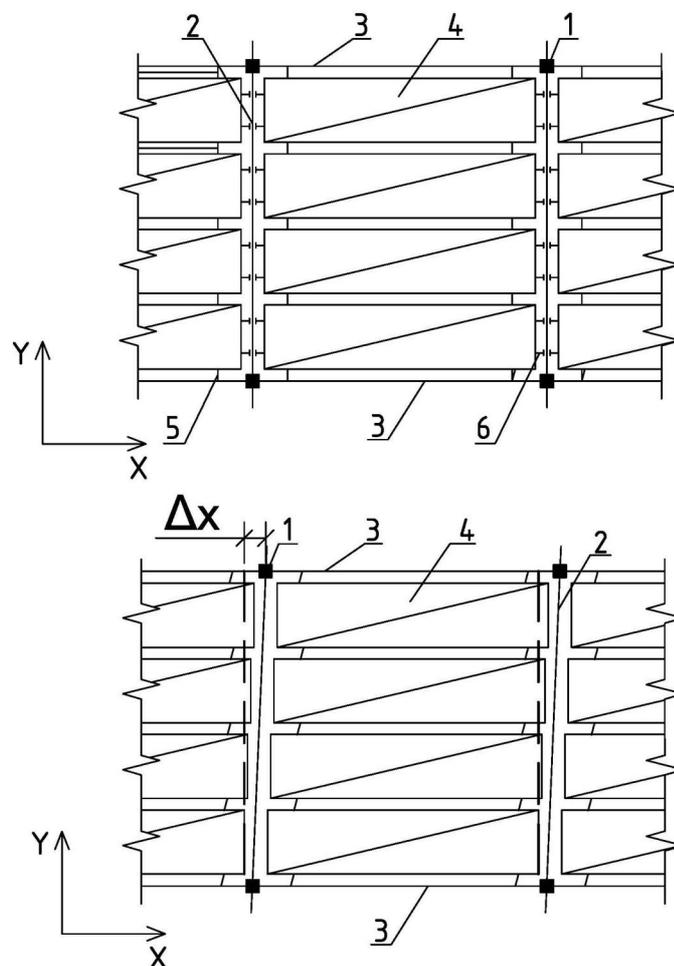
Связи сдвига между многопустотными плитами перекрытий безопалубочного формования
